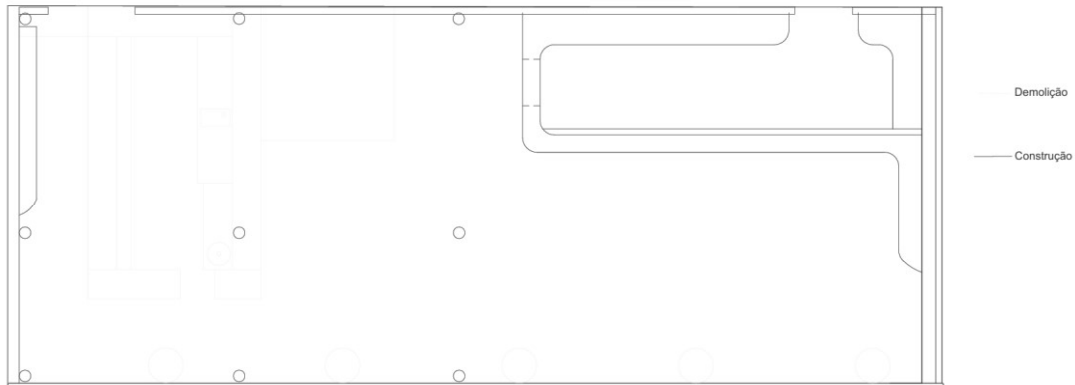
Planta de Alterações DECK (Camila Schmidt, 2025)
